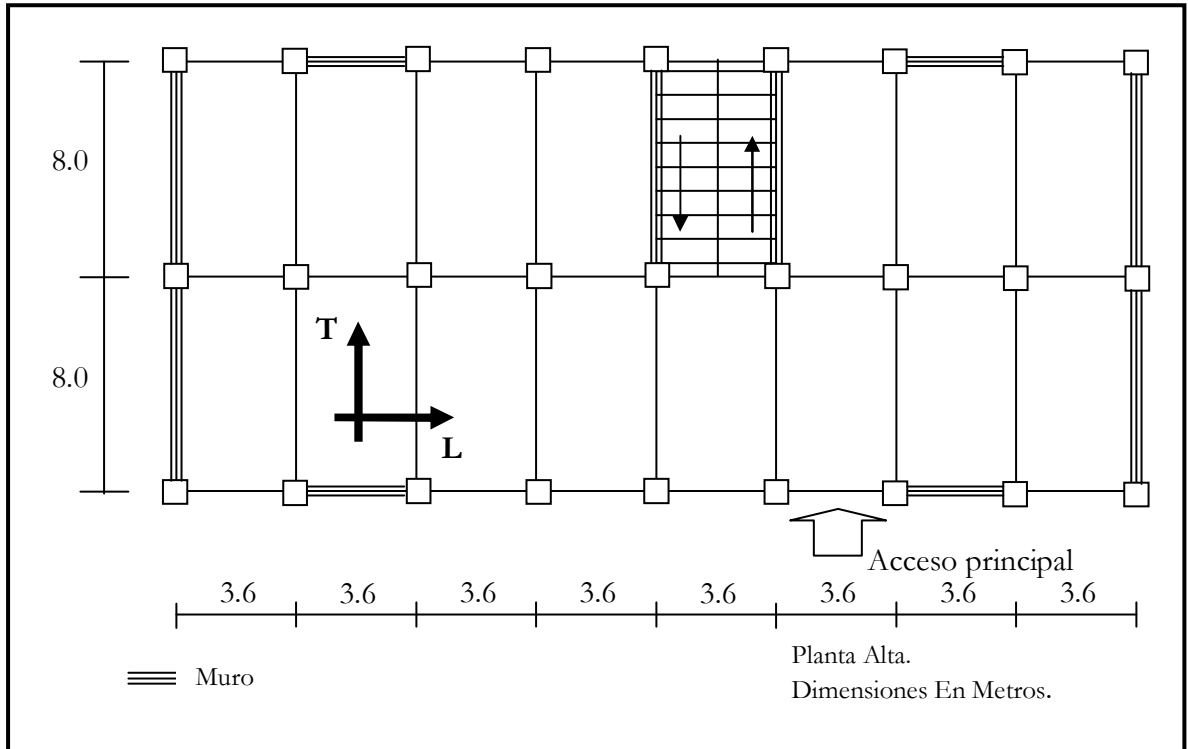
Planta Alta del edificio del Instituto de Ingeniería.
